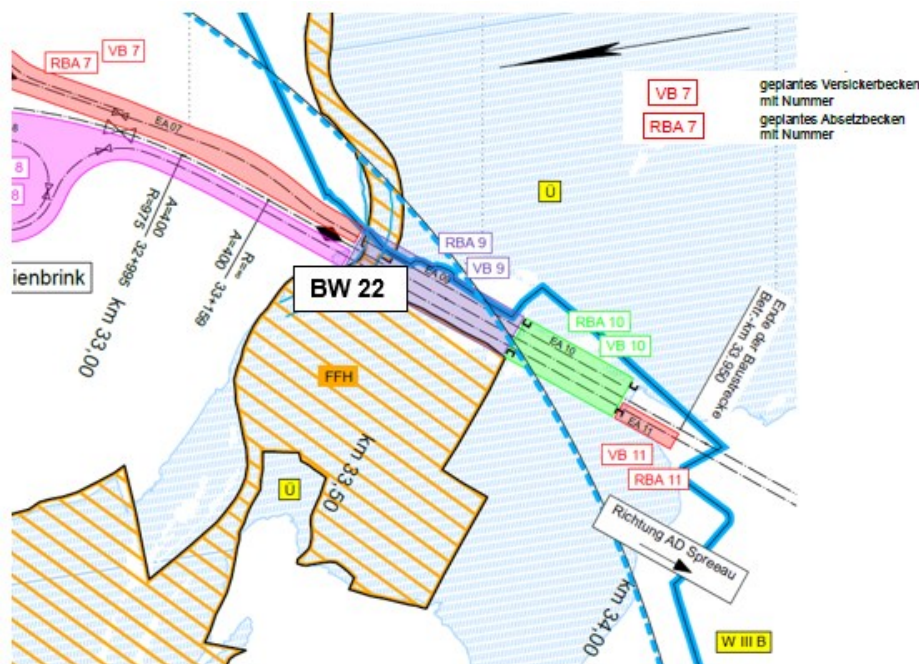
Ausschnitt „Lageplan der Entwässerungsmaßnahmen“ (Unterlage 8)
